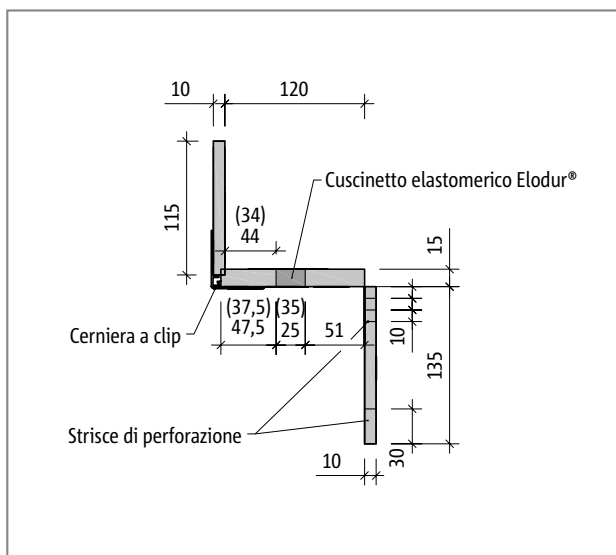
Schöck Tronsole® tipo F-V1, (-V2), sezione dell'elemento, sezione A-A, in caso di modifica della profondità minima della mensola
